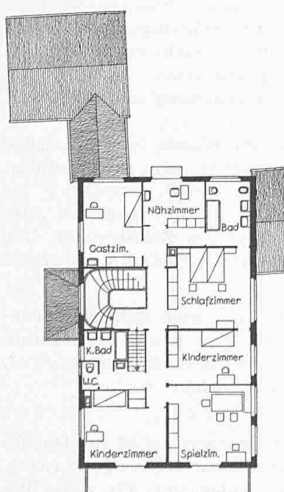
Grundrisse 1:400 des Hauses Sch.-E.
